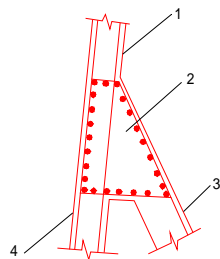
漏斗顶部钢筋混凝土仓壁环梁配筋示意图
